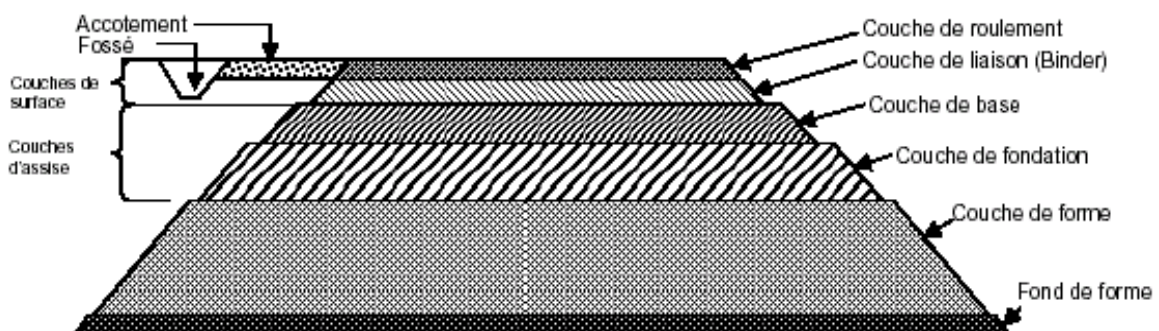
Coupe verticale d'un corps de chaussée.
